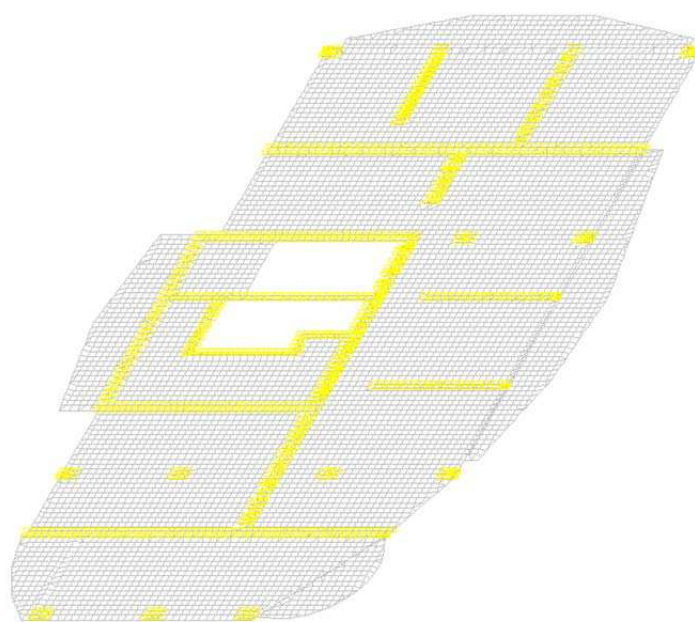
Расчетная схема монолитной плиты перекрытия
